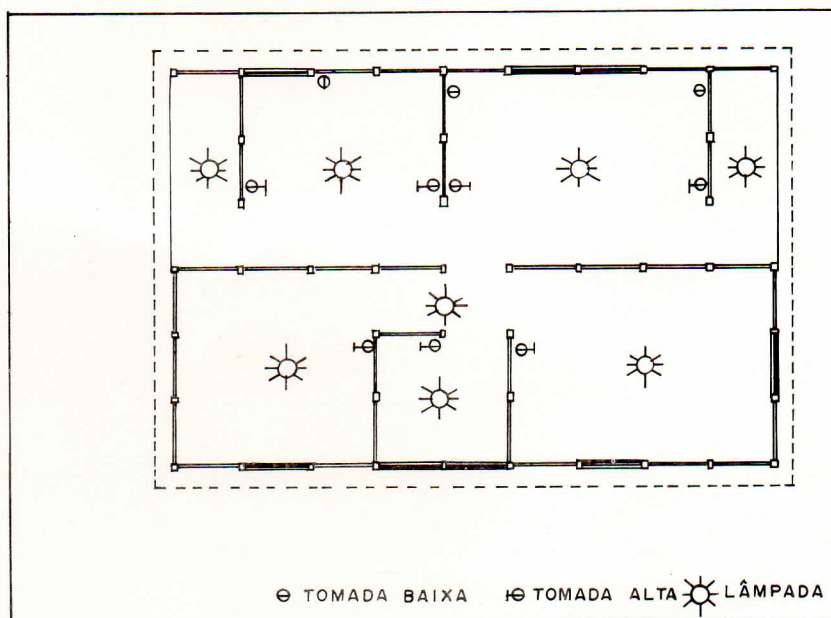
Planta baixa (locação dos pontos de eletricidade).
